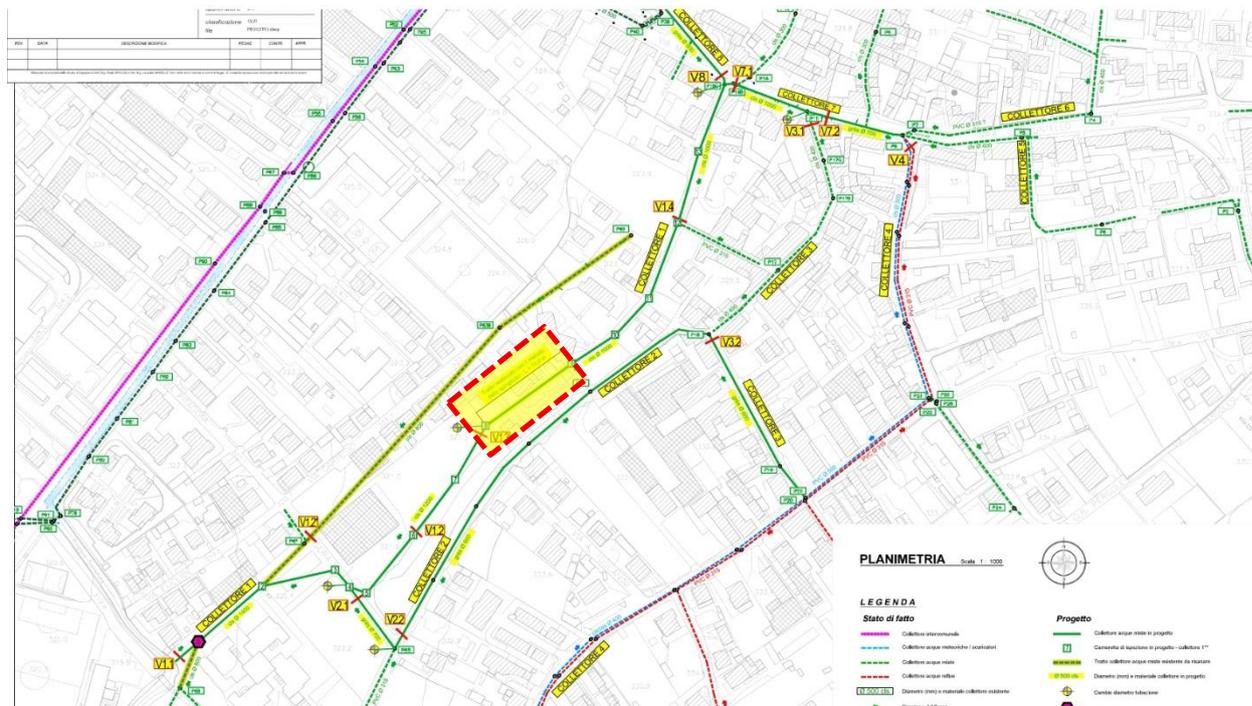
Progetto di fattibilità tecnico-economica - 2021 – Estratto della planimetria di progetto degli interventi previsti suddivisi in lotti (evidenziato il tratto da realizzare con tecnologia spingitubo)
